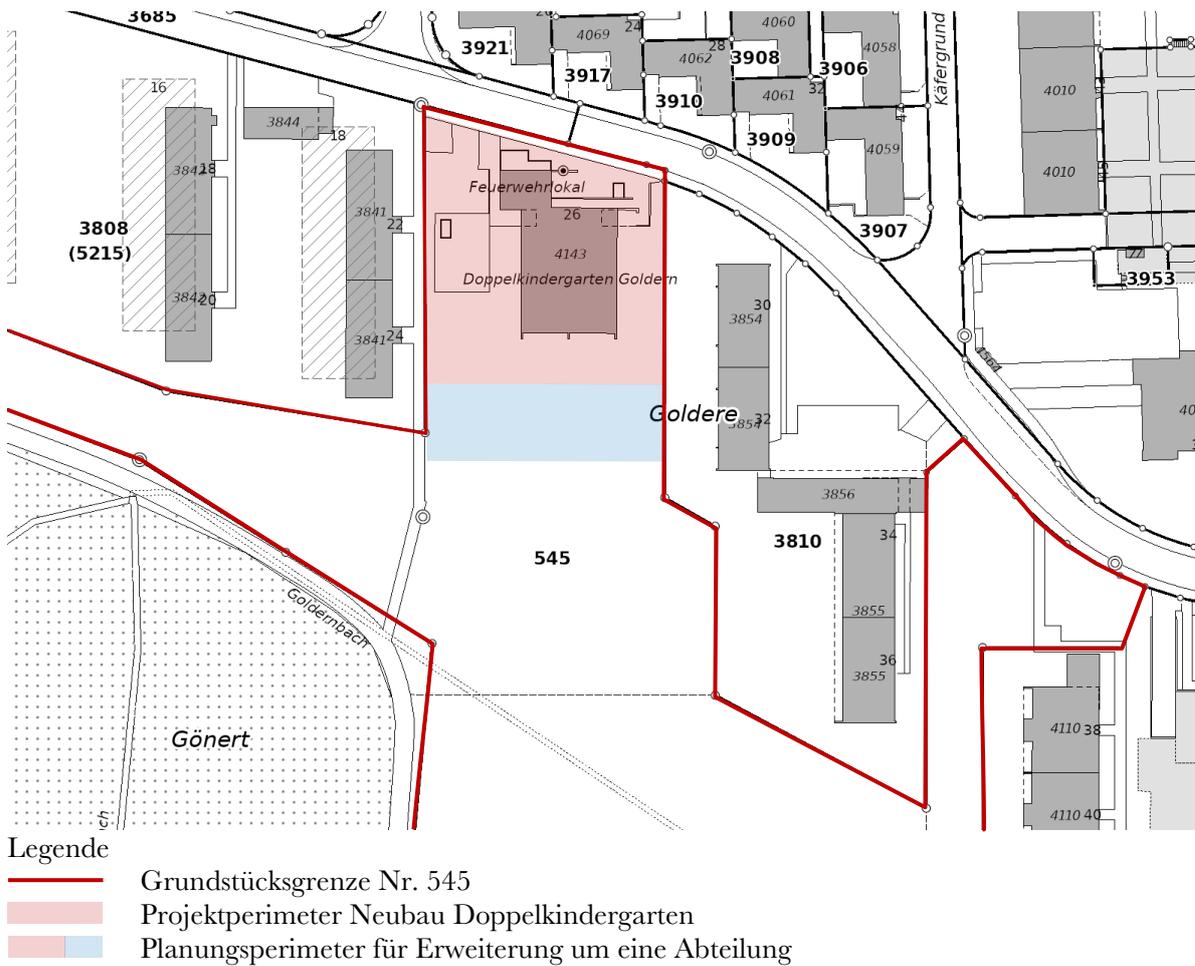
Ausschnitt Katasterplan mit Projekt- und Planungsperimeter (© Kanton Aargau, 2021)
